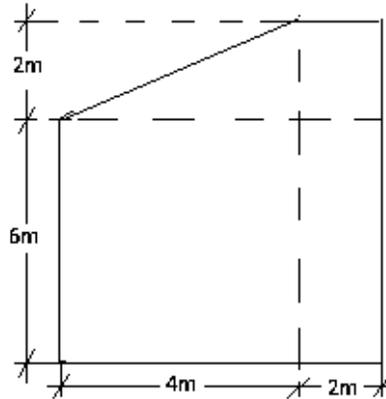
FIG. LOSA PERIMETRALMENTE APOYADA Y COLADA MONOLÍTICAMENTE CON APOYOS
